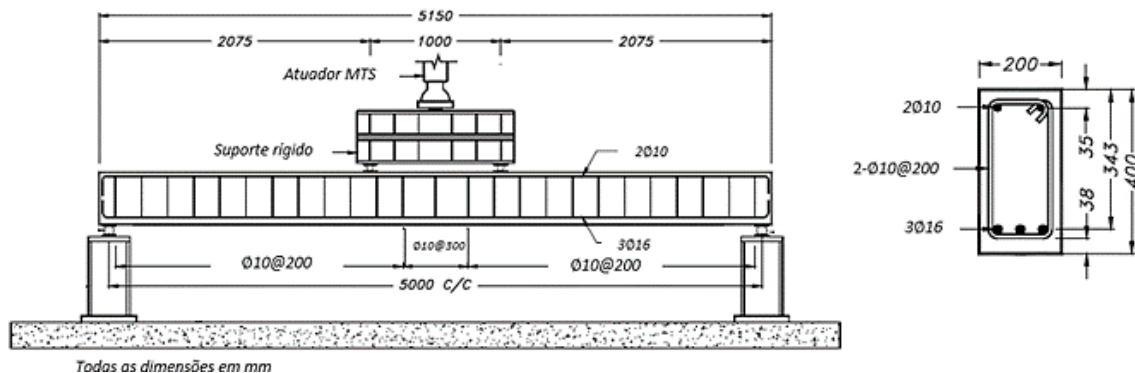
Configuração do ensaio, geometria e armaduras das vigas ensaiadas (adaptado de El-Hacha e Gaafar, 2011).
